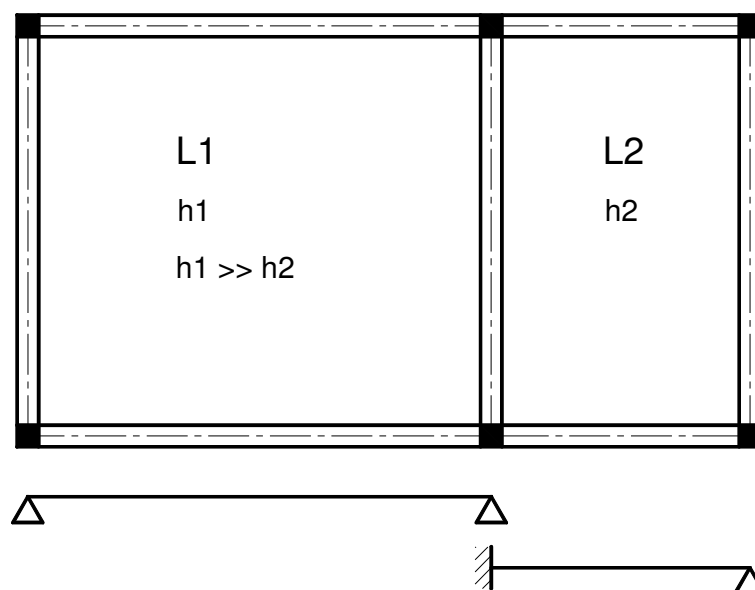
Lajes adjacentes com espessuras muito diferentes.
